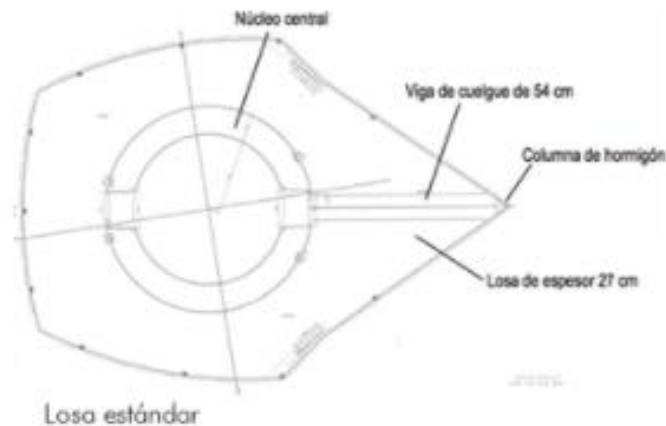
Representação do sistema de núcleo central em planta baixa do Turning Torso (Fonte: Mañanas, 2015).
